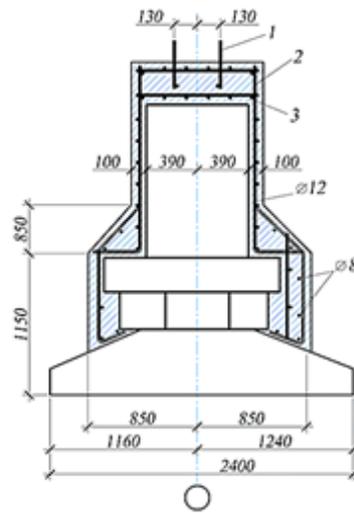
Усиление монолитного ленточного фундамента уширением основания с использованием железобетонной обоймы: 1 – анкерные болты; 2 – сварные сетки; 3 – обоймы
